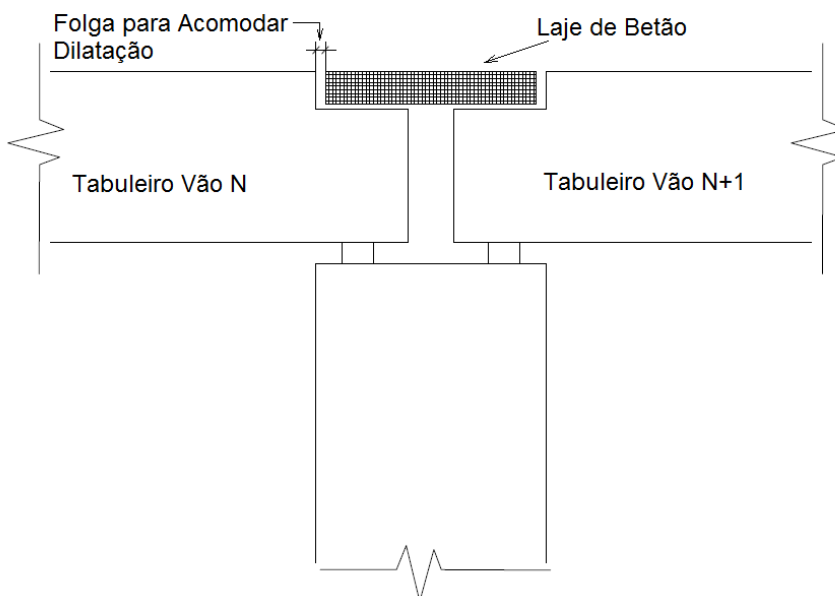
Representação esquemática de junta com laje de betão armado [31].
